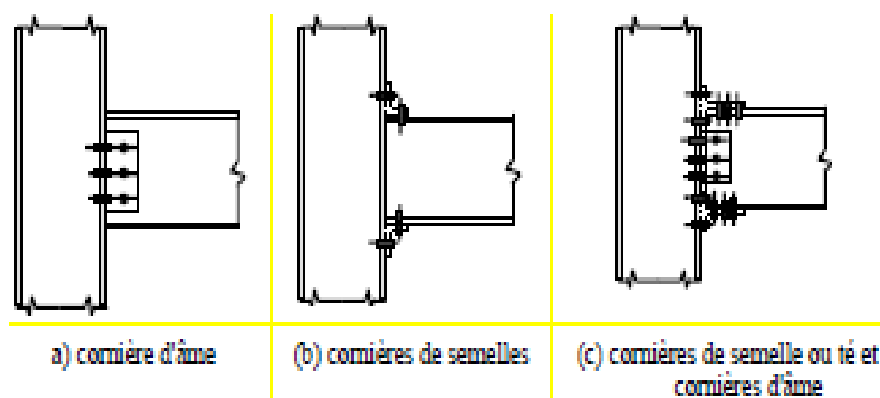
Assemblage poutre-poteau par cornières d'âme et/ou des semelles
